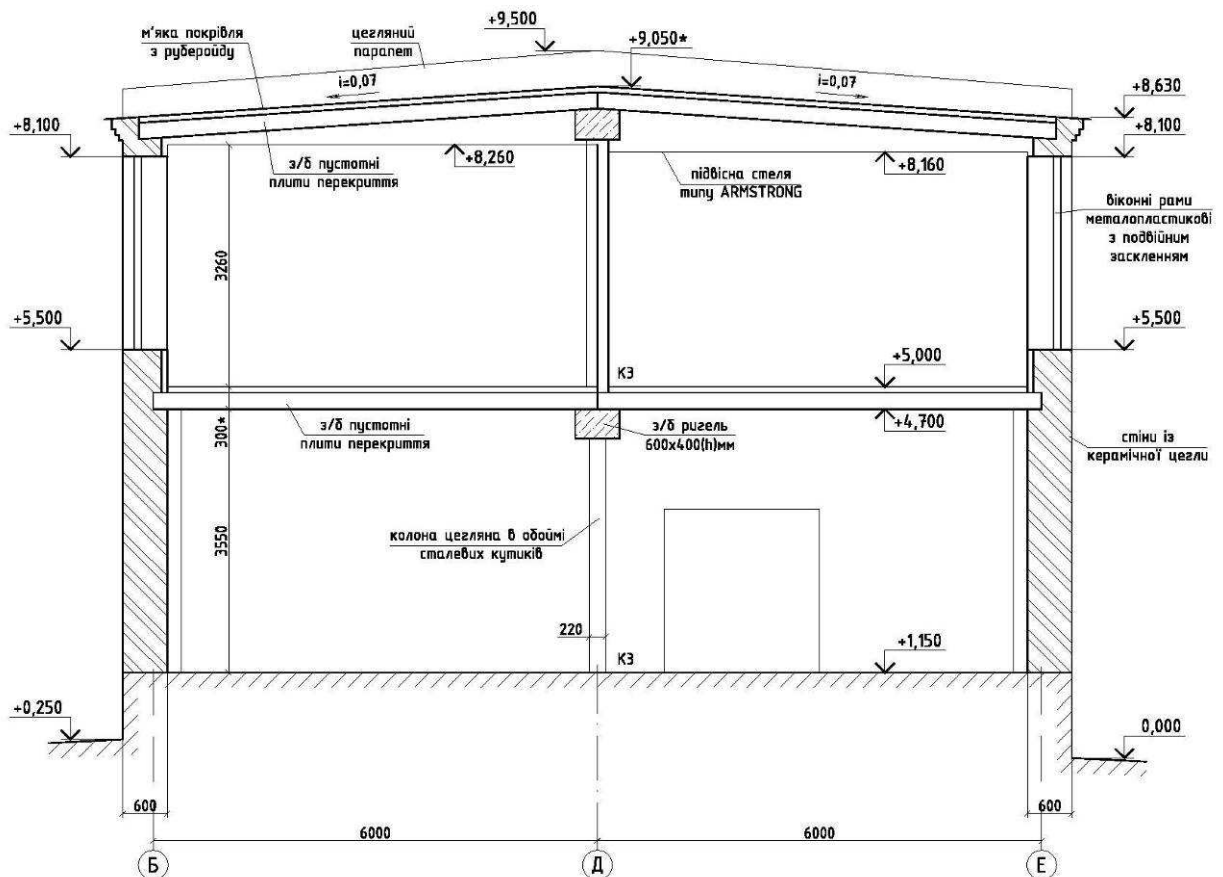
Поперечний розріз 2-2 між осями 4-8 будівлі цеху фасування, складу тари
